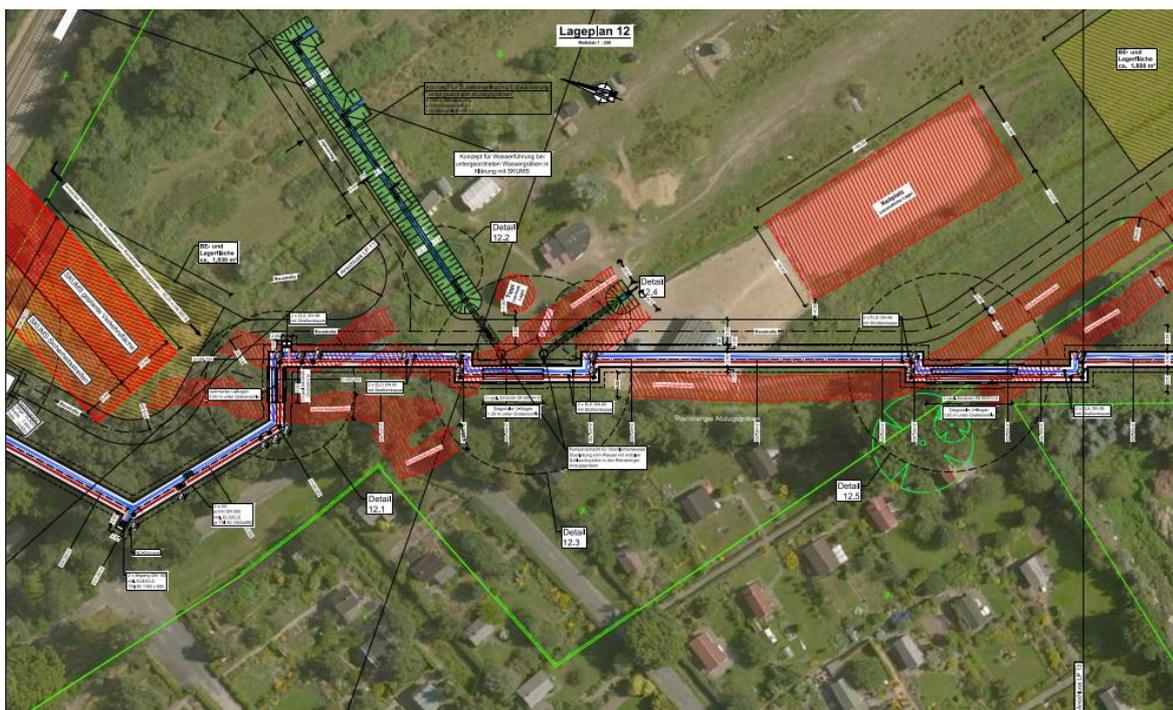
Abschnitt 9 - Gelände „Kinder Wald und Wiese e. V.“ Plan 2.2.12
